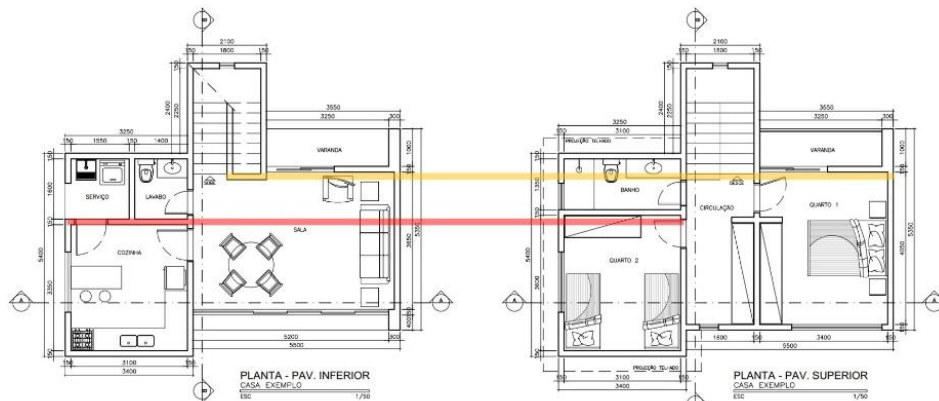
Plantas do projeto de arquitetura original, de ambos os pavimentos, demonstrando paredes desalinhadas
